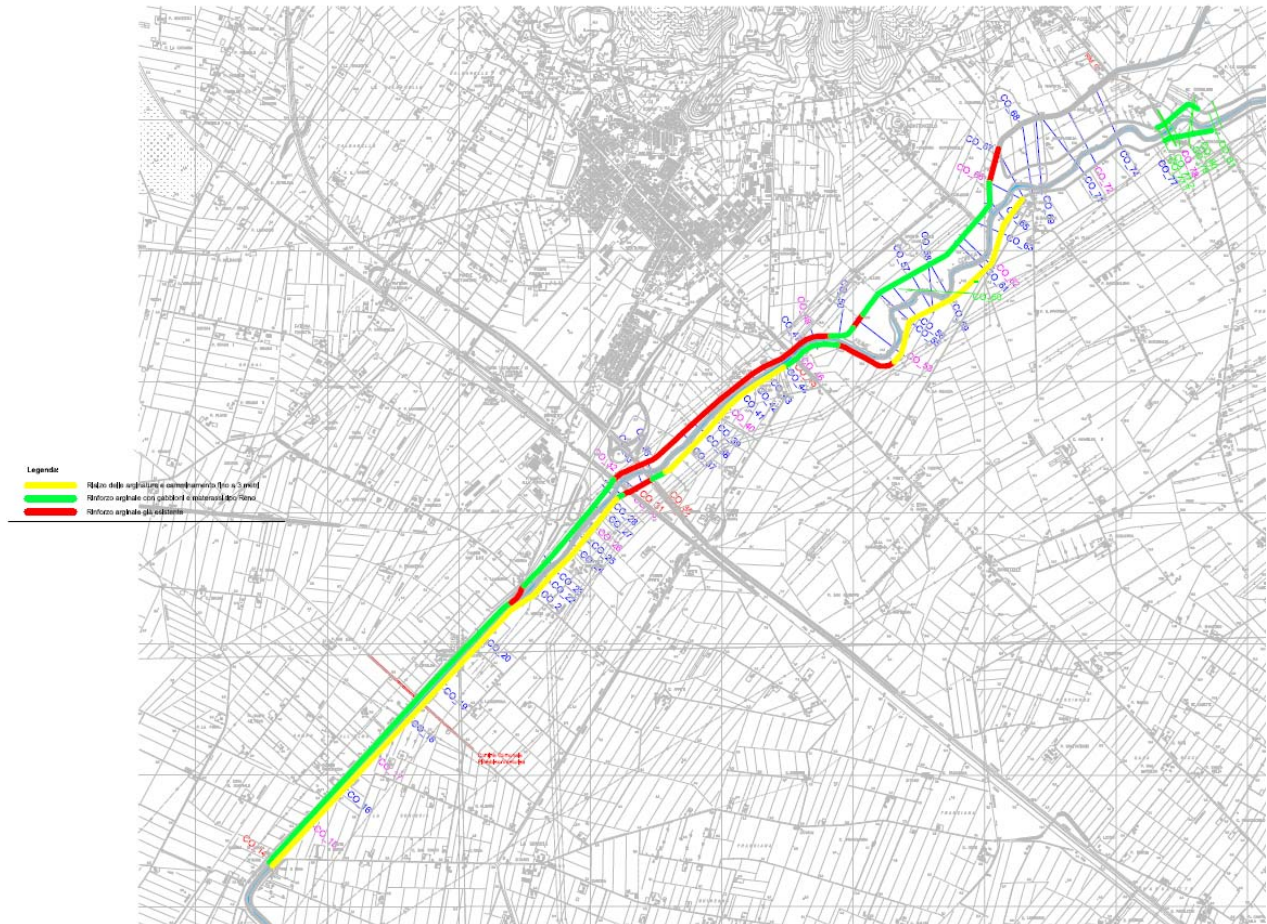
Interventi previsti sulle arginature (stralcio Tav.1 del progetto preliminare del Consorzio)
